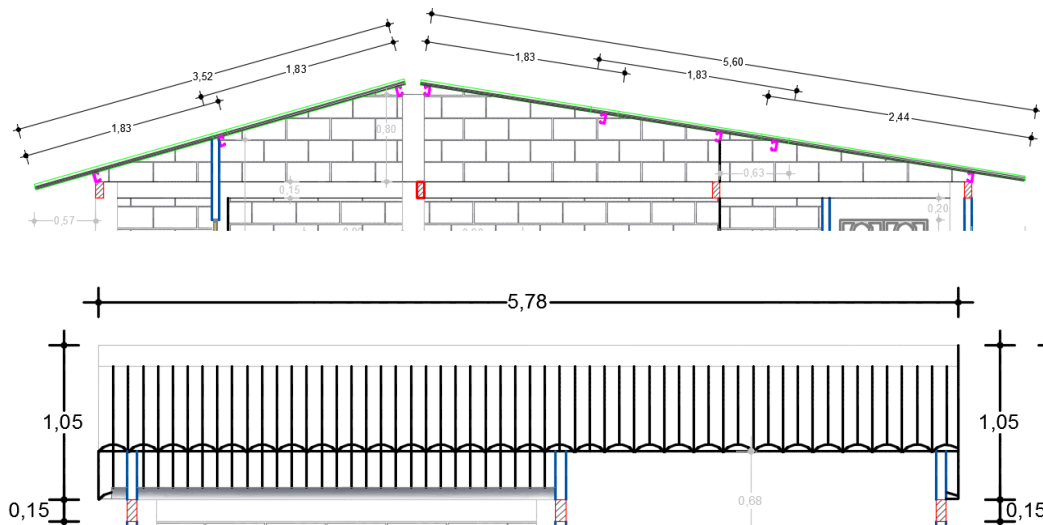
Vista del techo de la Vivienda Modelo.
